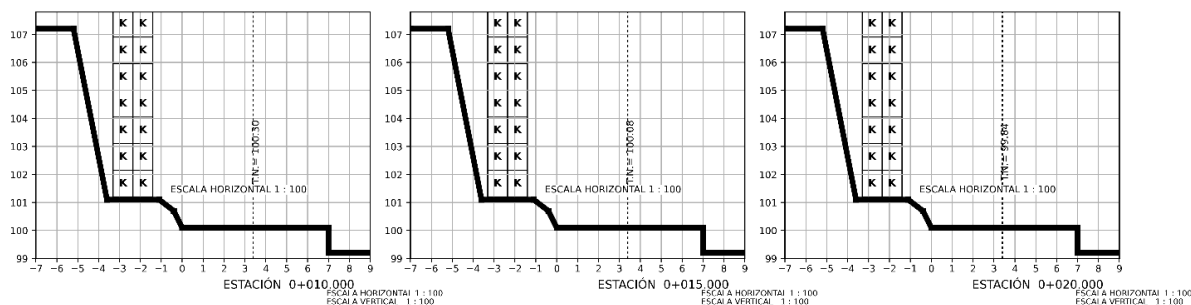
Perfil transversal en estación 0+010 (elevación 100.30 m); en estación 0+015 (elevación 100.08 m); en estación 0+020 (elevación 99.84 m).
